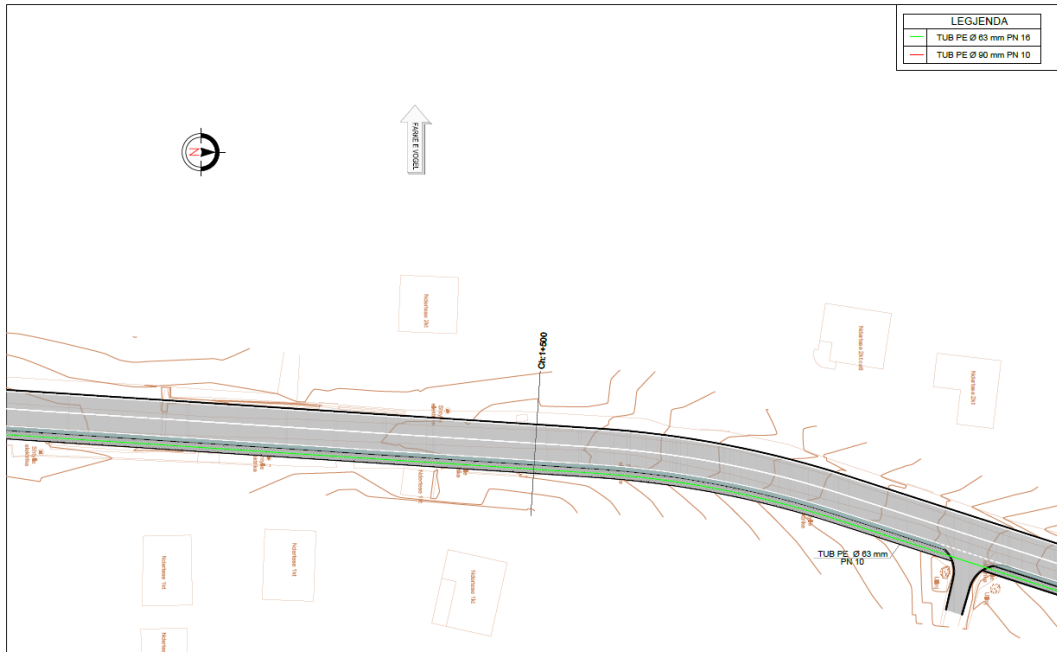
Plani i rrjetit te ri te ujesjellesit
